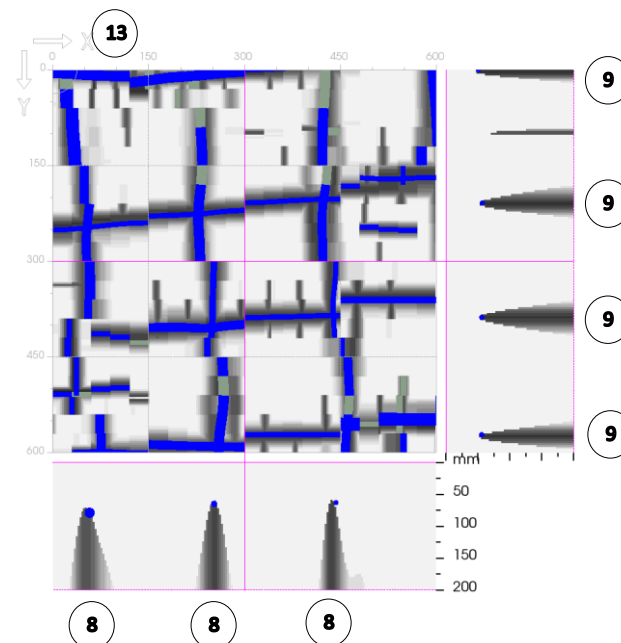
Ferrailage reconnu – Poutre Pt04
